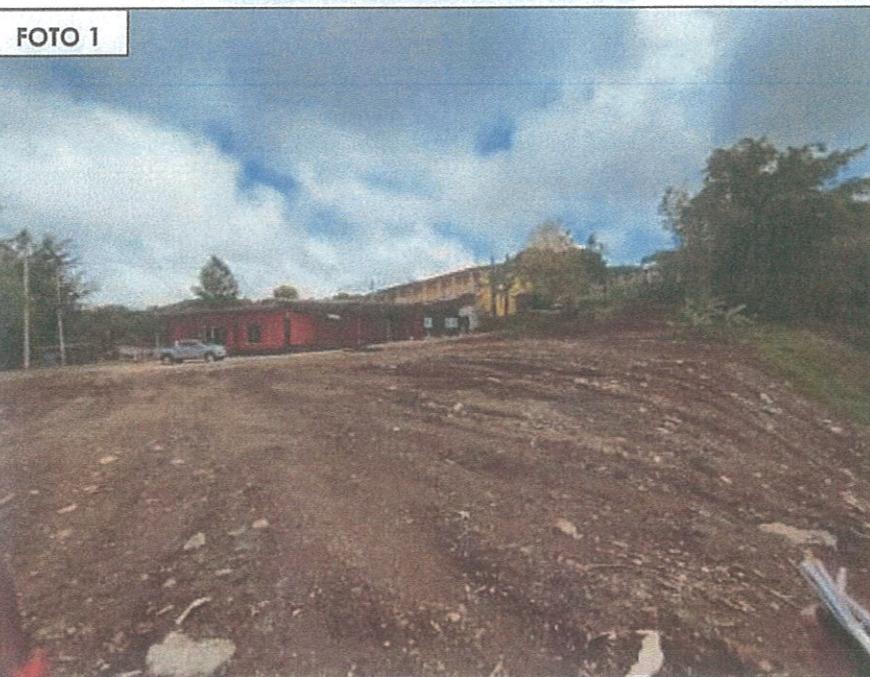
VISTA DEL ÁREA CON RELLENO.
